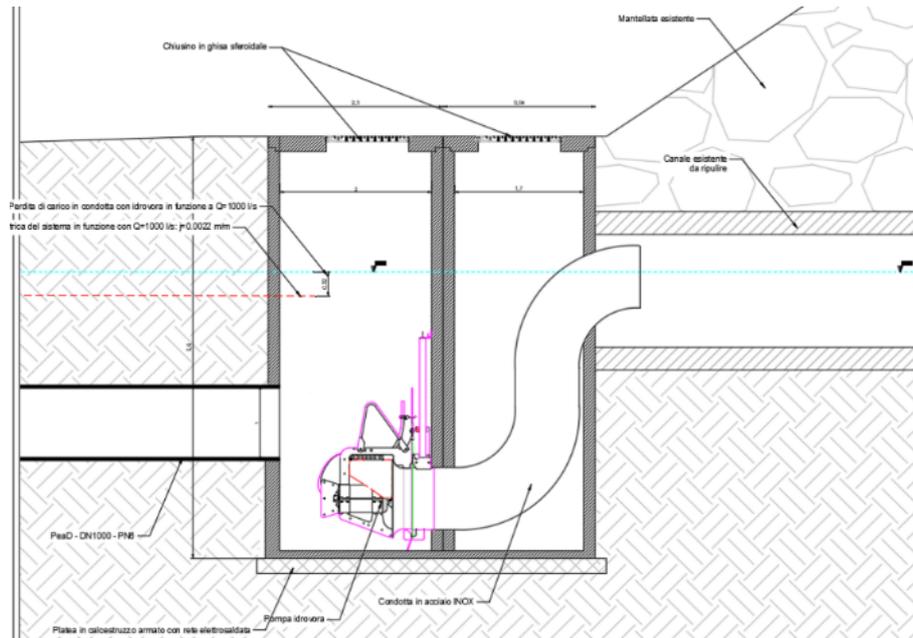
Pozzetti di ricircolo di progetto – sezione trasversale.
